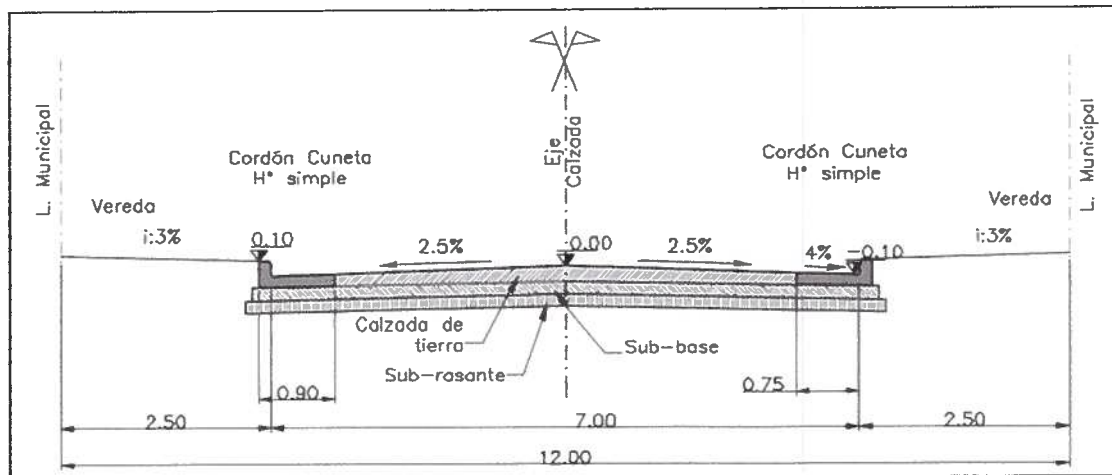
Perfil transversal tipo 1. Calzada Tierra
